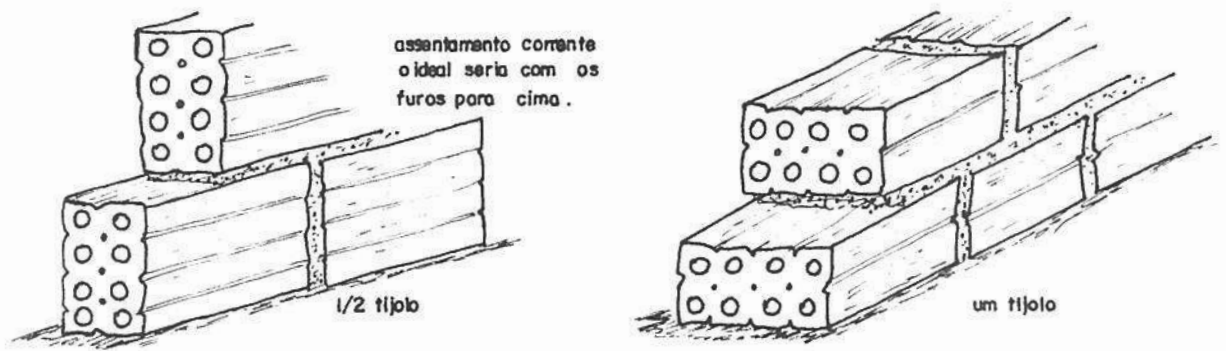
Execução de alvenaria utilizando tijolos furados.
